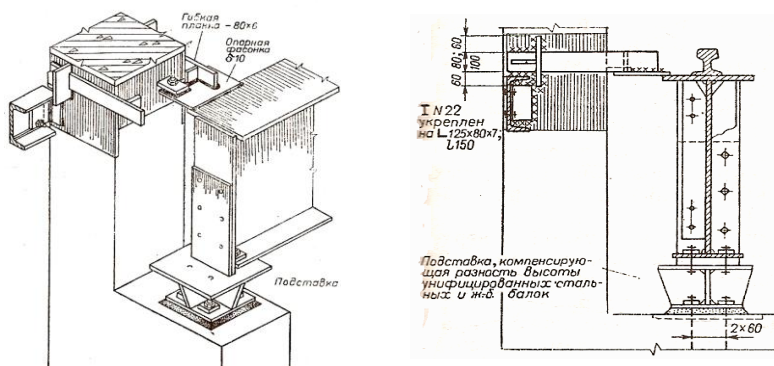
Крепление стальных подкрановых балок к железобетонным колоннам
